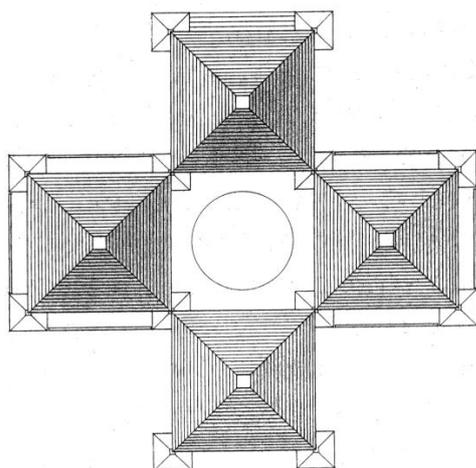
Louis Kahn, Centro Comunitário Judaico, Trenton, New Jersey, 1954-1959, planta parcial de cobertura.
